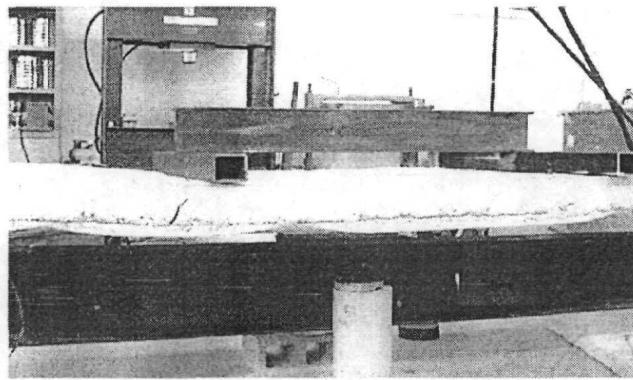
Grieta de falla en tensión diagonal sobre losa compuesta
